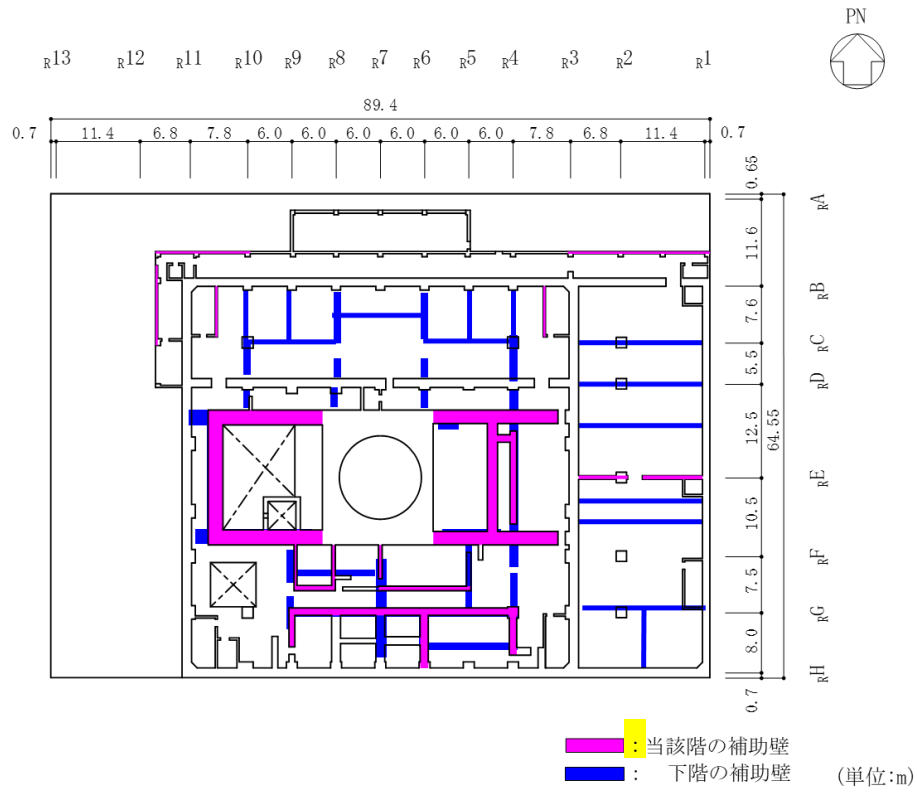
(5) 補助壁の配置図 (EL 34.8m)
